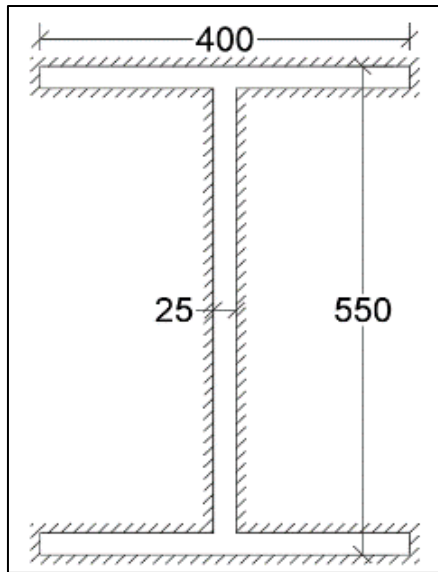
Perfil de la Columna "C1" - Sistema estructural mixto.
